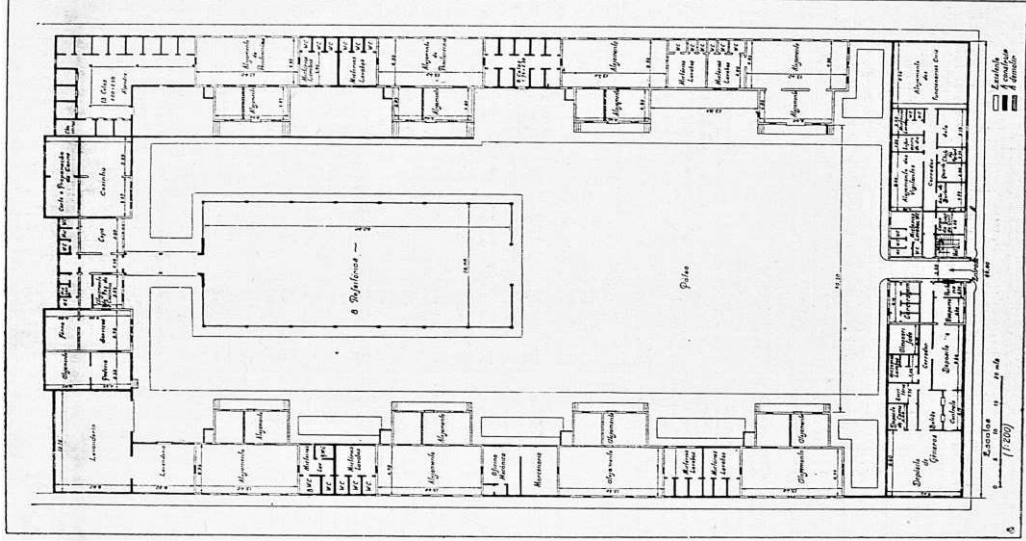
Planta do Presídio da Ilha Anchieta, 1942.
